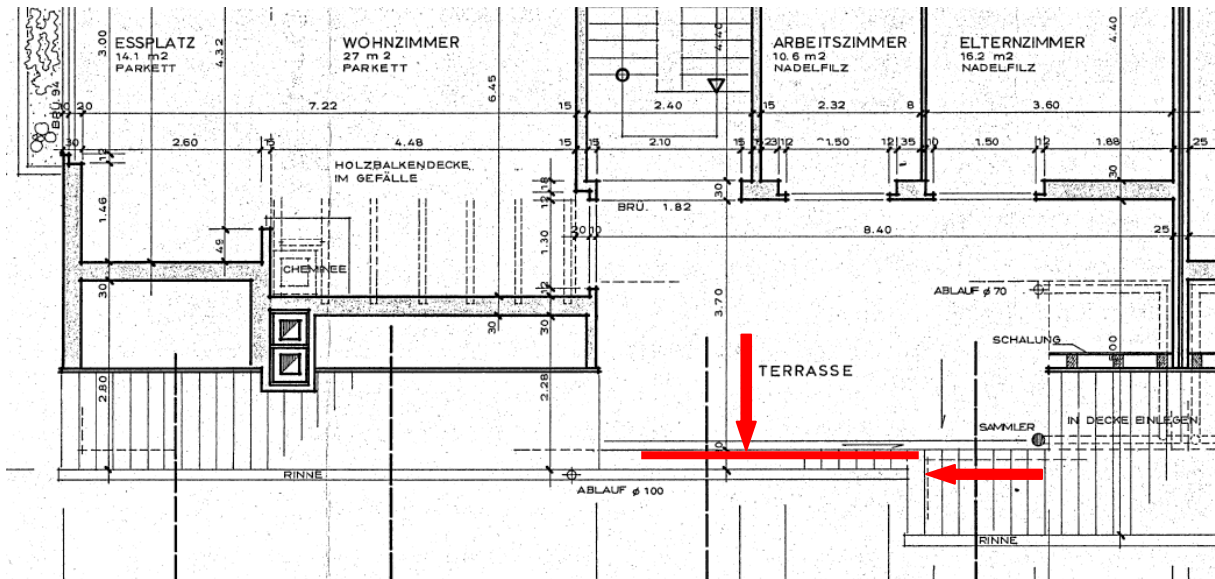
Grundriss Fassadenriss Brüstung Terrasse DG
